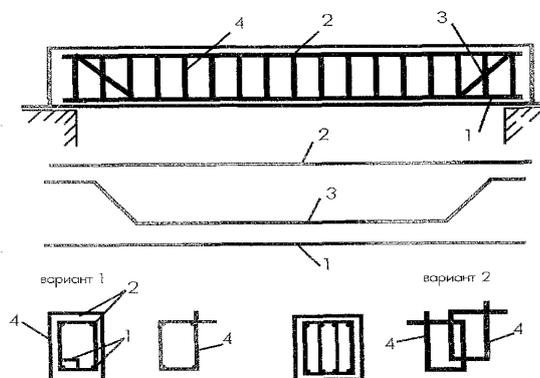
Армирование железобетонных балок вязаными каркасами:
